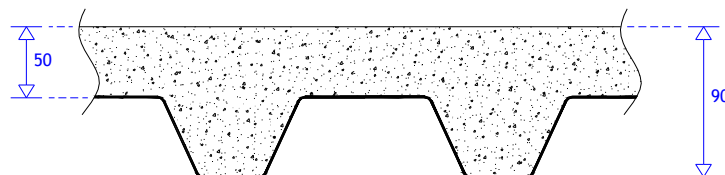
Espessuras mínimas [mm] da secção transversal de uma laje mista com funções de diafragma.
